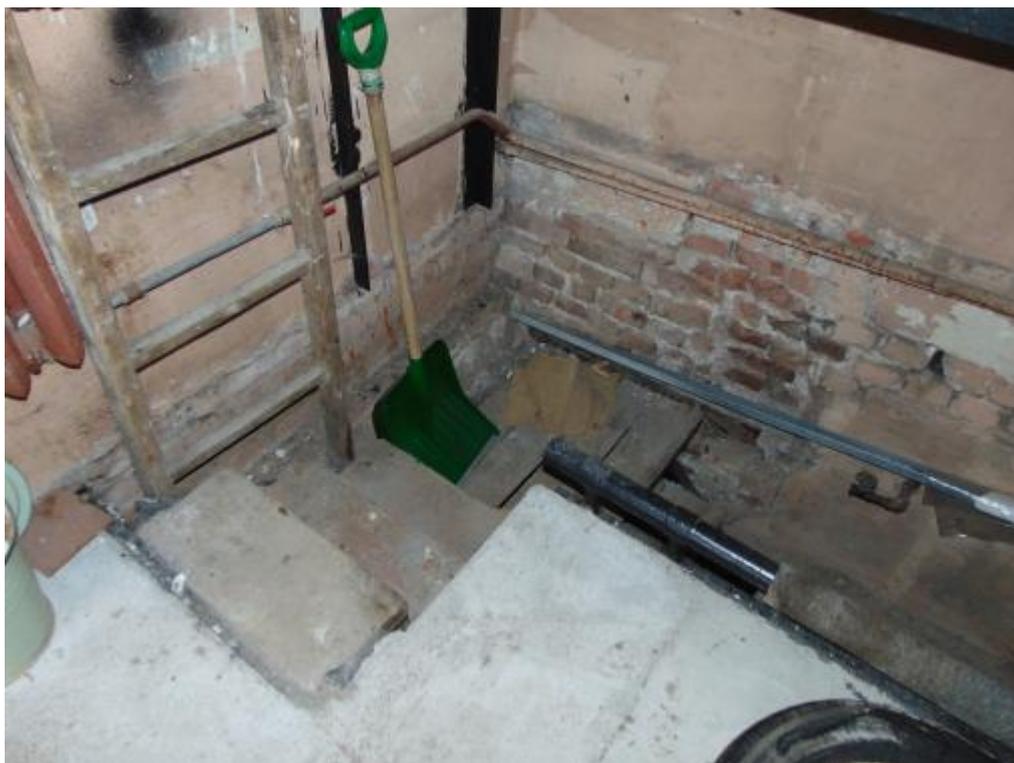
Подвал. Выявлено разрушение штукатурного покрытия на поверхности фундаментных стен. Разрушений и деформаций конструкции фундаментов не выявлено.
